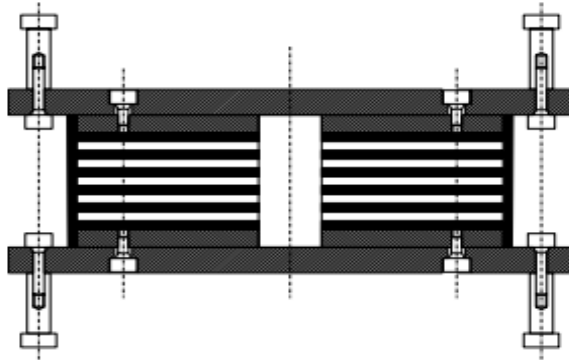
Aislador de elastómero zunchado con núcleo de plomo (LRB)
